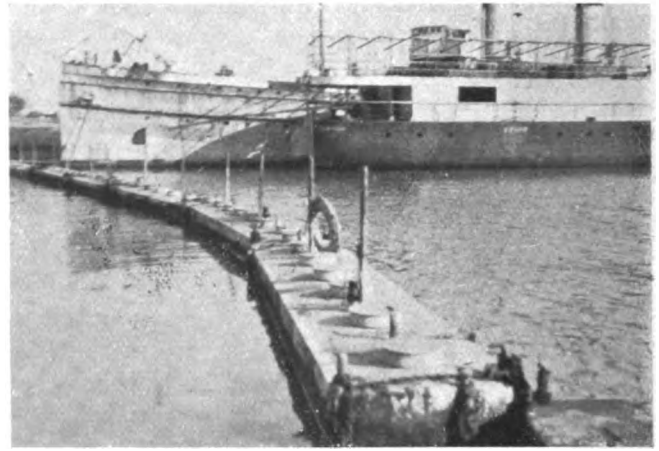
Beton-Schwimmbrücke im Hafen von Buenos Aires
